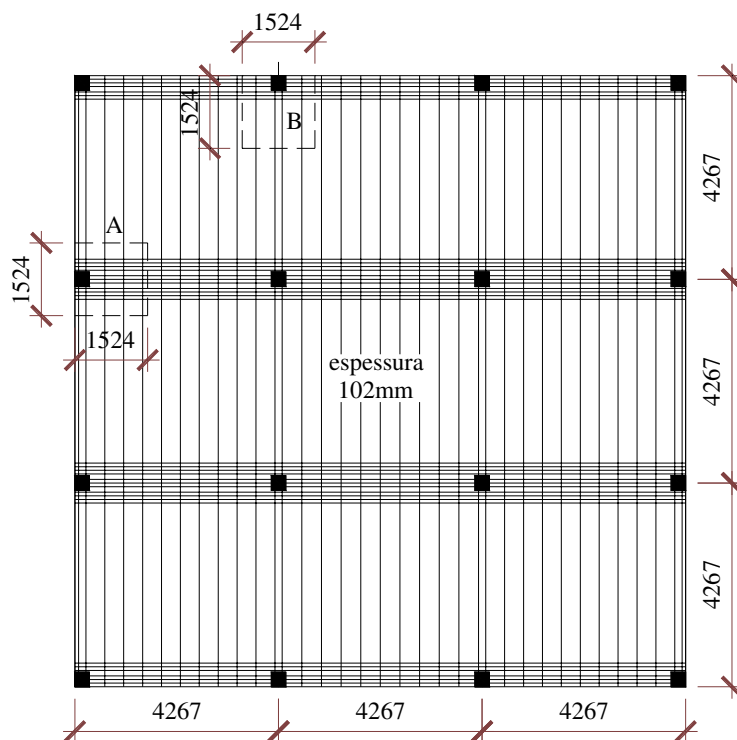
Modelo global do pavimento em laje cogumelo protendida (mm). FOUTCH-GAMBLE-SUNIDJA/1990
